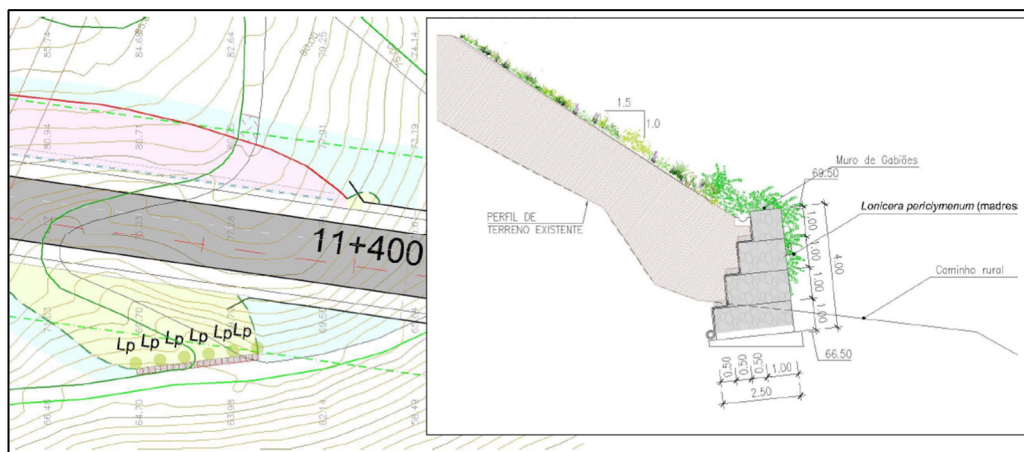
Enquadramento do Muro de Suporte M2. Encontro E1 da Ponte sobre a ribeira das Ardias. Plantação *Lonicera periclymenum* (madressilva) no topo do muro
